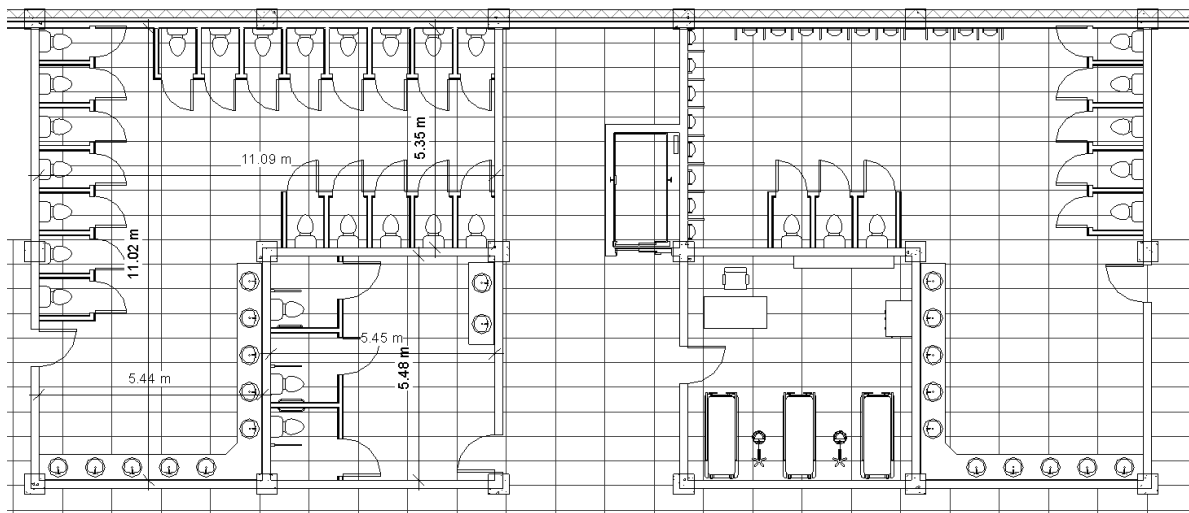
Vista en planta del sector sur. Fuente: elaboración propia.
